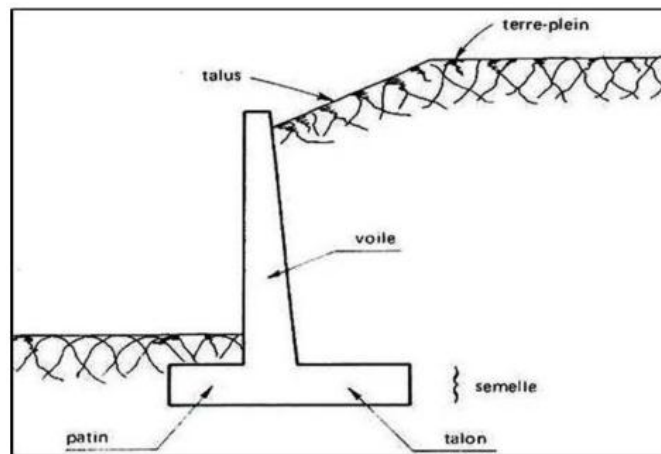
Profil en travers d'un mur cantilever en béton armé.
